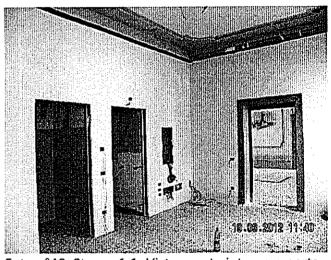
Stanza 1.1- Vista parete interna e porta sala (stanza 1.4)
